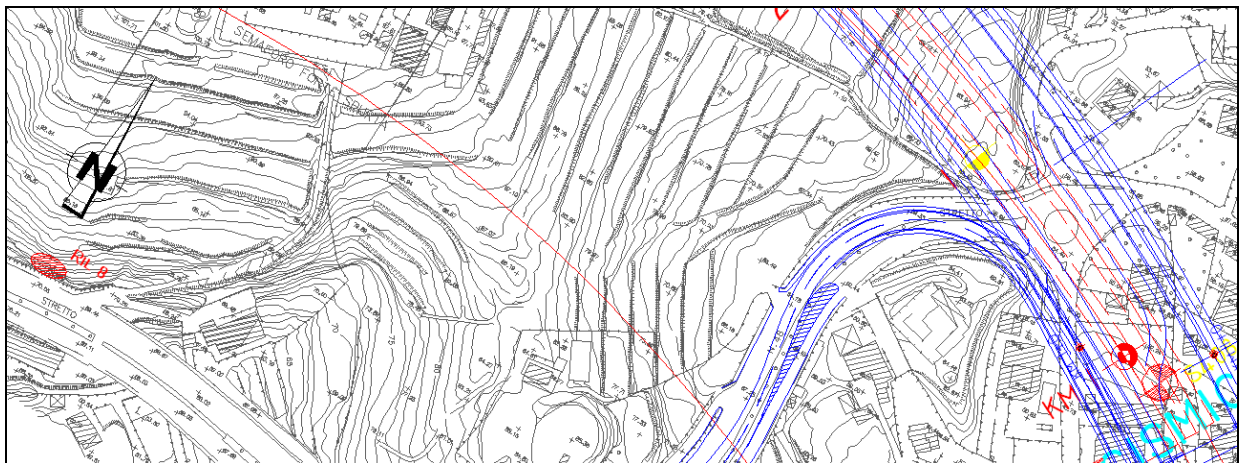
Ubicazione in planimetria dell'affioramento oggetto del rilievo geostrutturale
